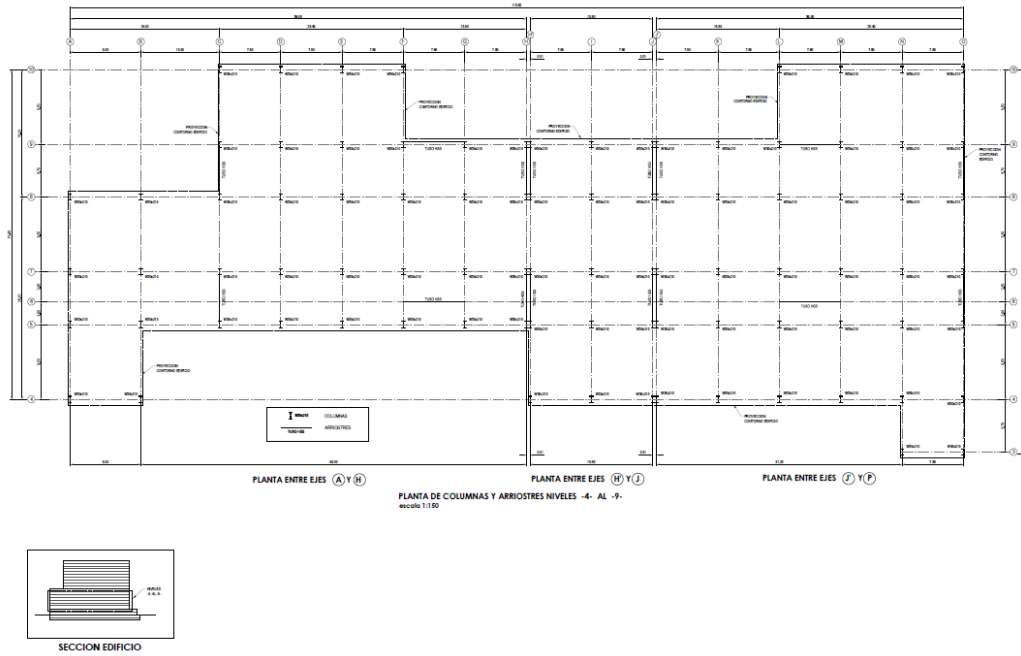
Planta Estructural Columnas, Muros y Arriostres. Nivel 4-9
